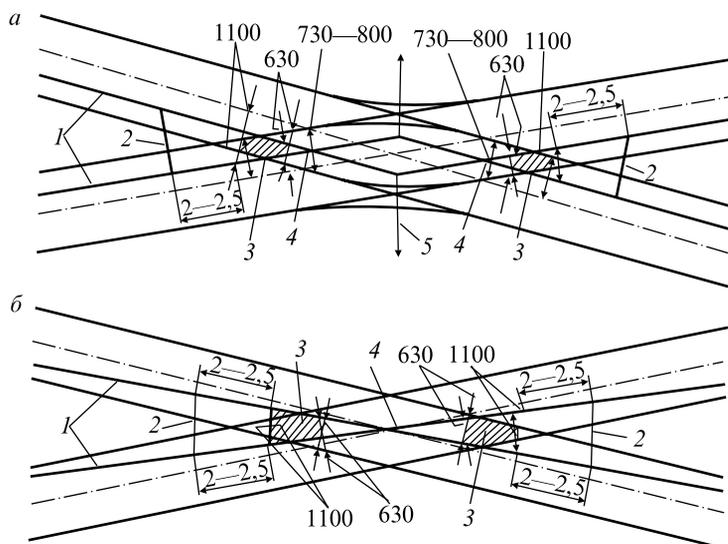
Схемы воздушной стрелки: *a* — при перекрестном стрелочном переводе; *б* — при глухом пересечении путей; 1 — контактные провода пересекающихся путей; 2 — электрические соединители; 3 — зона подхвата ползком токоприемника контактных проводов; 4 — место пересечения контактных проводов; 5 — фиксирующее устройство
